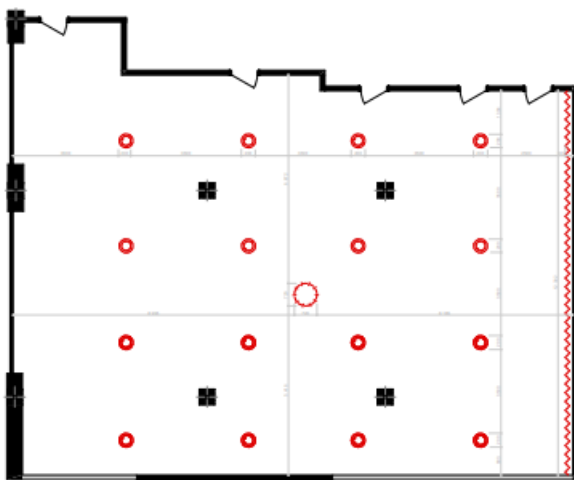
План стелі приміщення з розташуванням освітлювальних приладів
